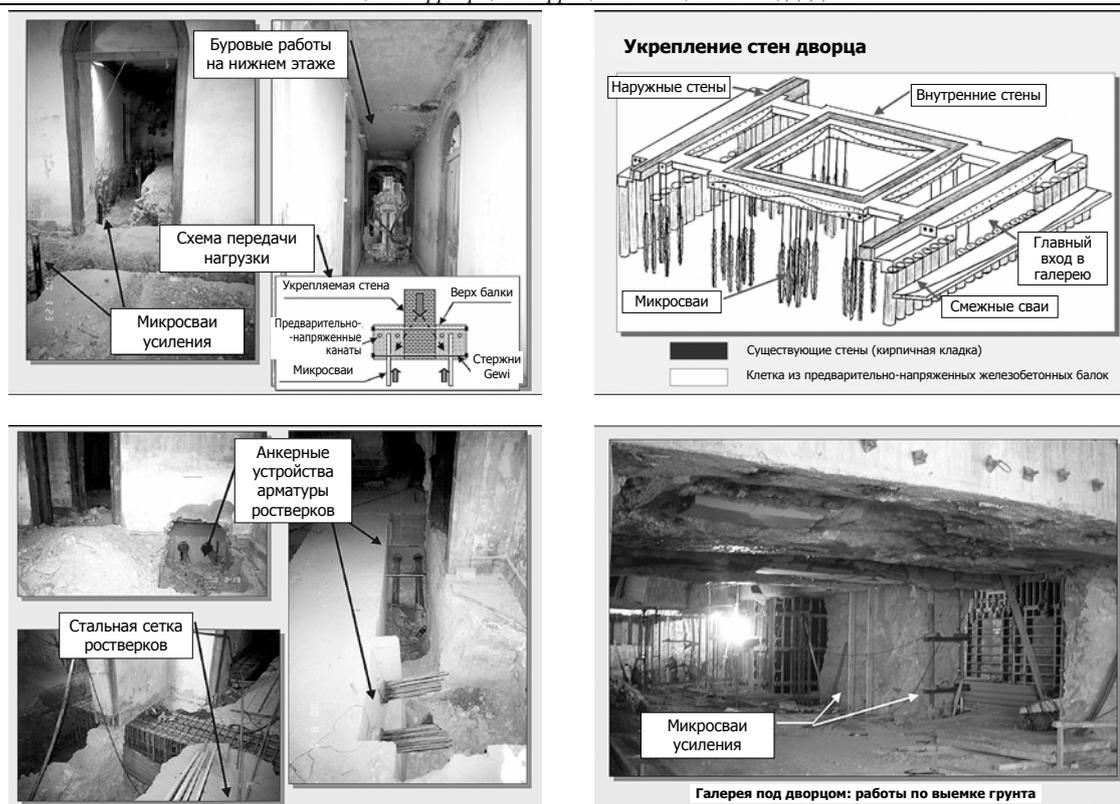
Сетка из предварительно-напряженных железобетонных ростверков и вид котлована под дворцом
